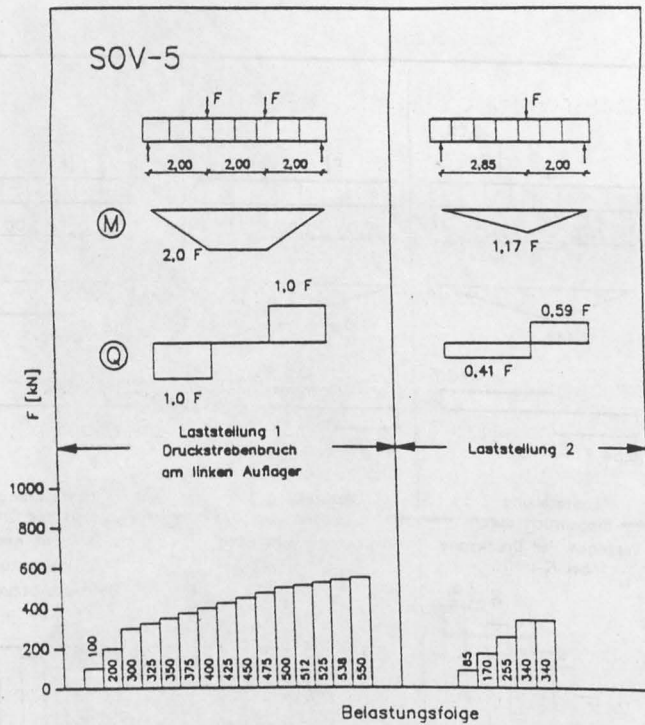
Laststellungen und Laststufen zum Versuch SOV-5
